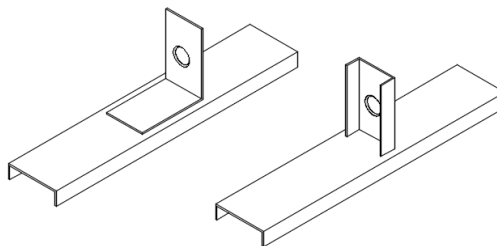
Disposición del ángulo receptora de la estructura de la cubierta
